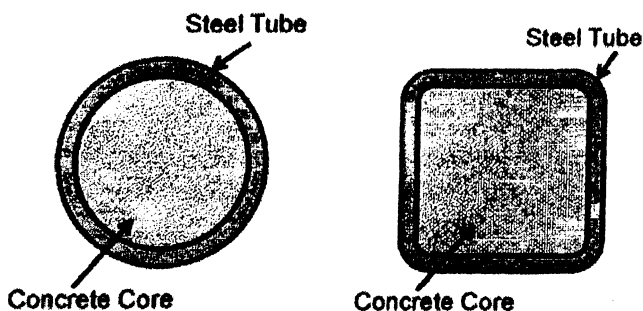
Поперечное сечение круглой и прямоугольной трубобетонной колонны
